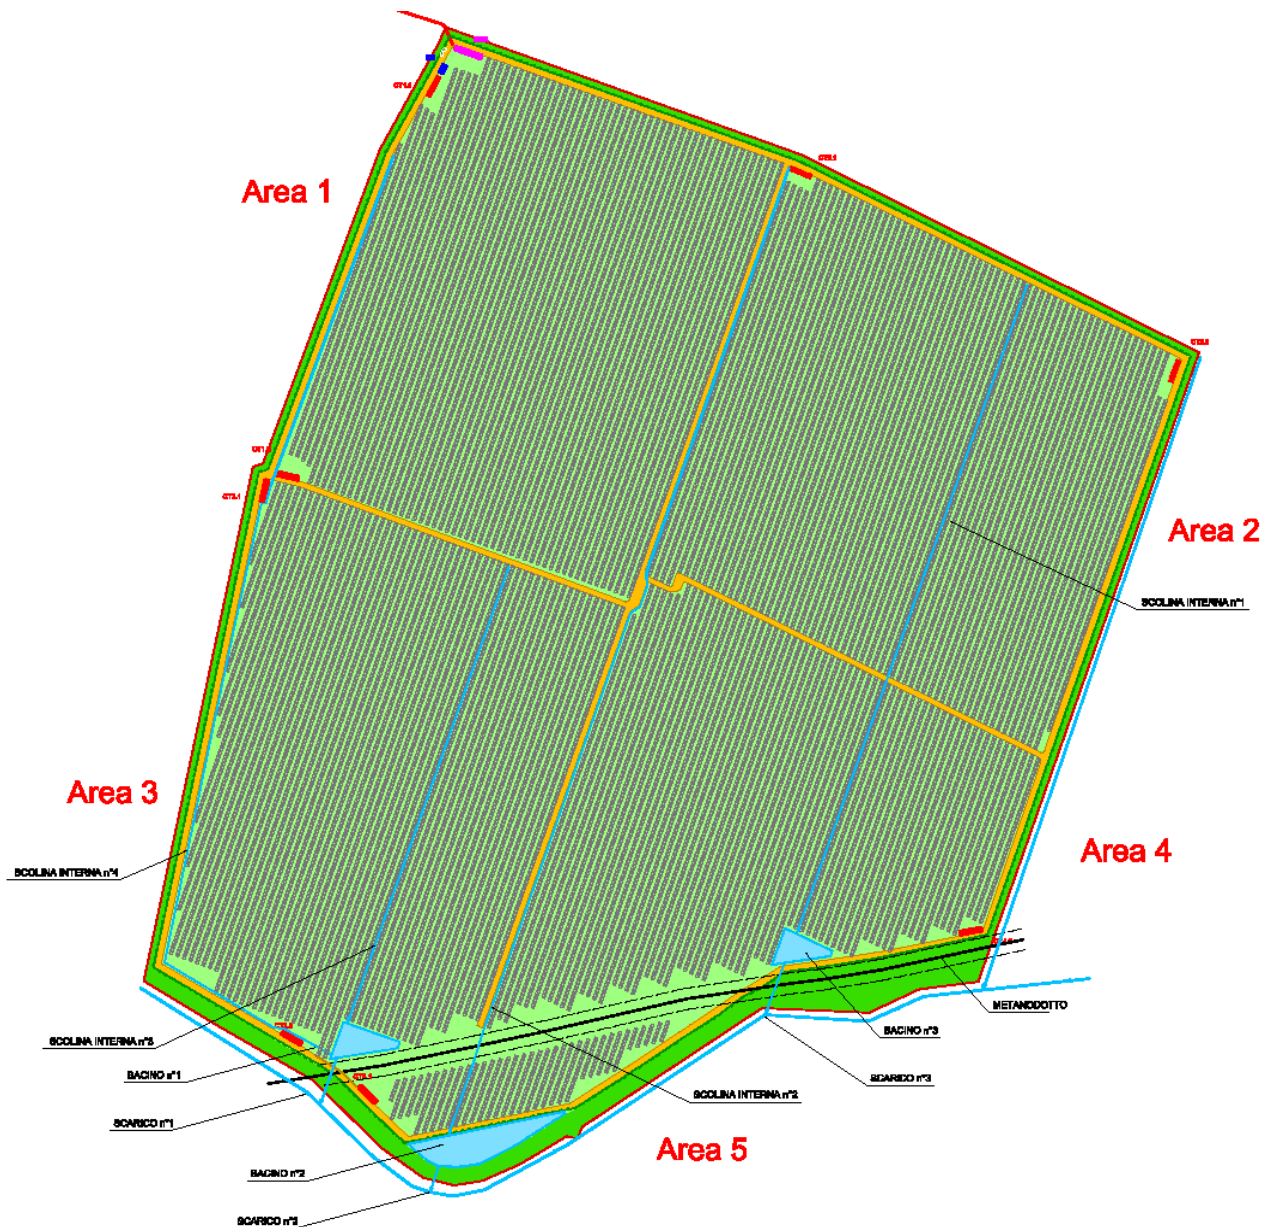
Planimetria generale - ubicazione dei bacini di laminazione e punti di scarico
